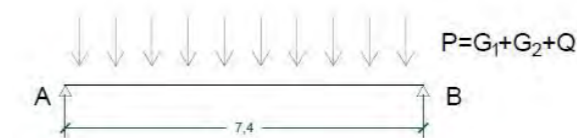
Schema statico della trave T1.1. Fonte: Autori.
